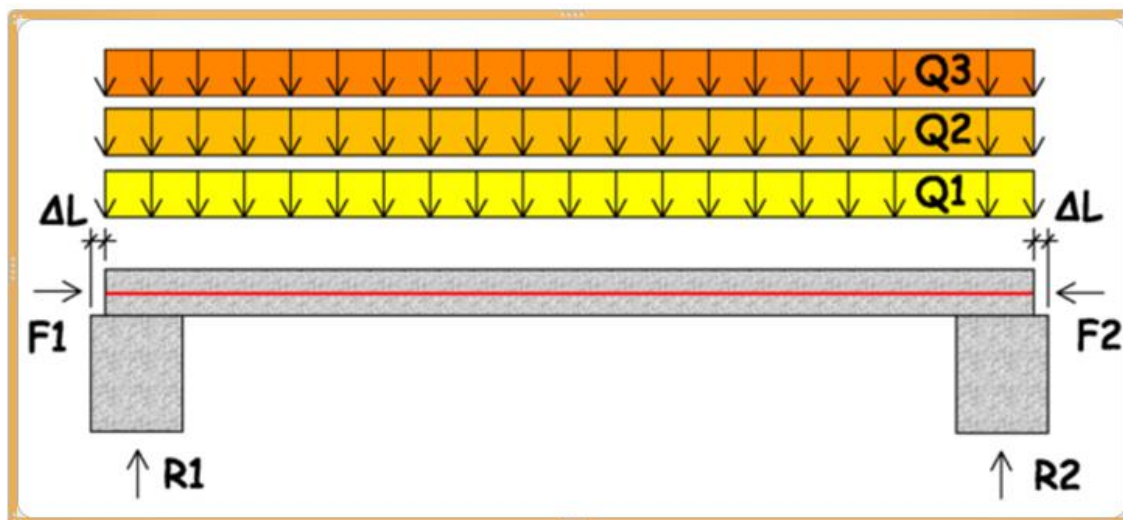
Viga bi apoiada com armadura ativa e carregamentos (Autora, 2015)
